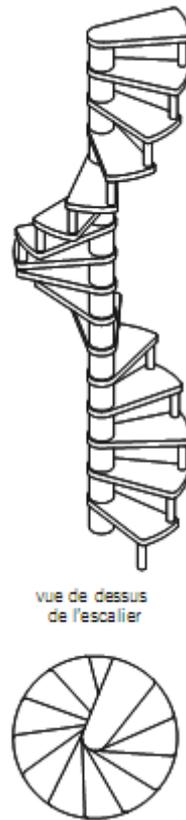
Escalier hélicoïdal en bois sur plan circulaire.
